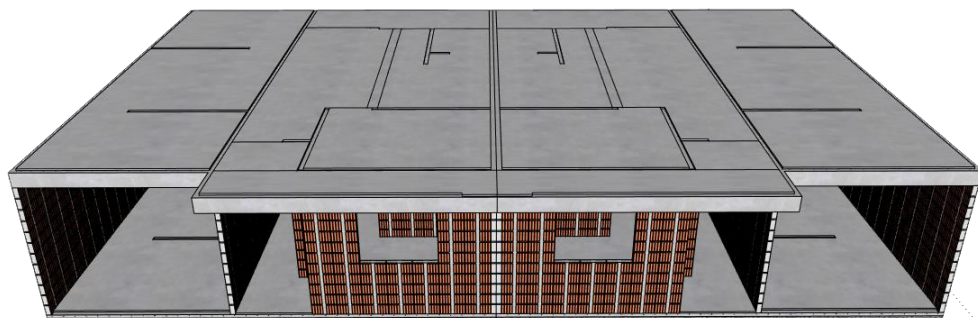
Montagem das vigotas de concreto armado, dos elementos de EPS e da malha de aço para concretagem da laje treliçada do primeiro pavimento
